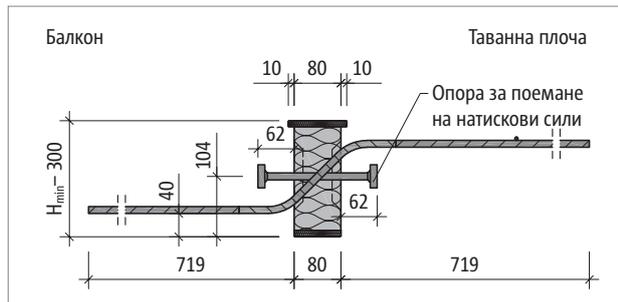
Schöck Isokorb® T тип QP-V4: Сечение на продукта
